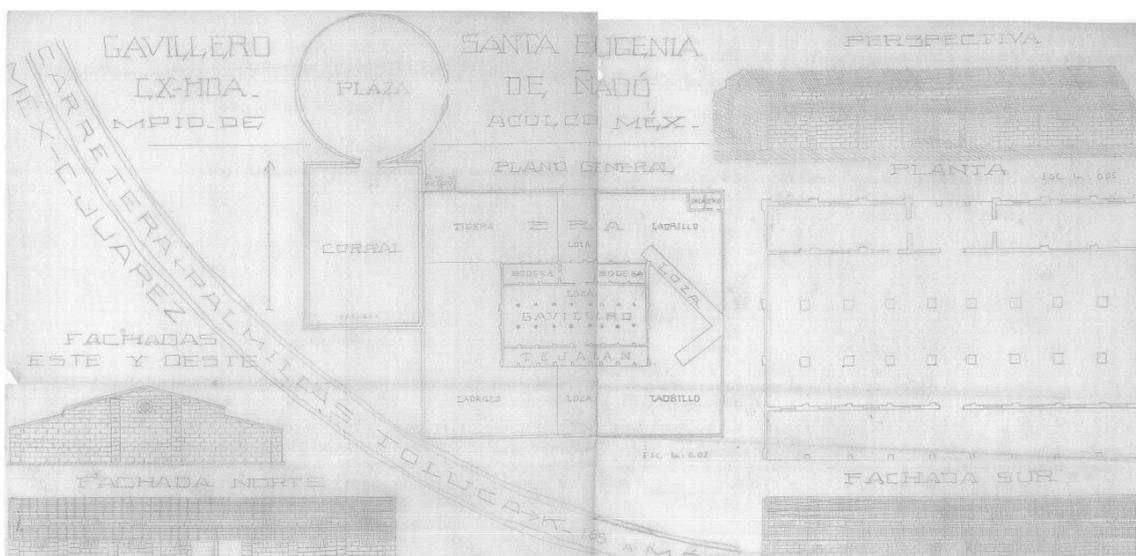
Plano del Jacal de Ñado de 1949 Fuente José Luis Navarro
